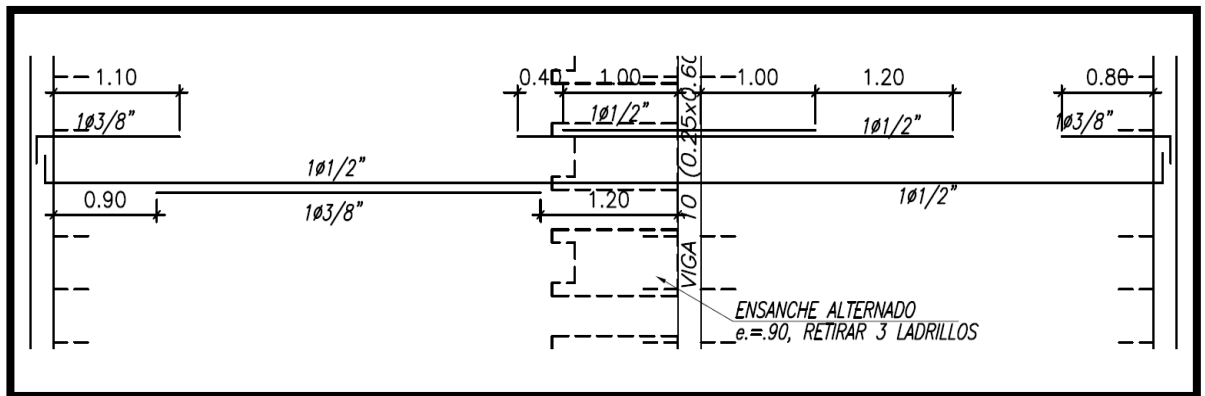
7 Vista en planta del refuerzo del aligerado para los pisos 3, 5 y 7
